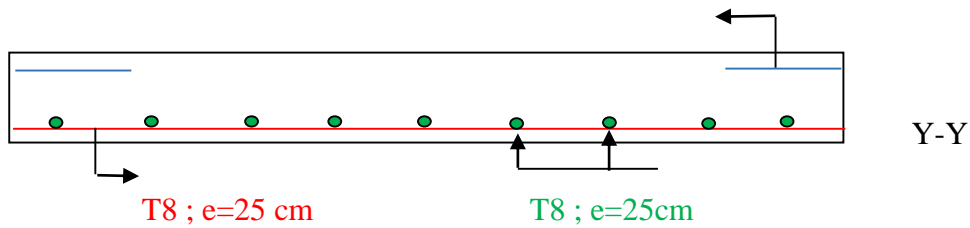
Disposition constructive des armatures de la dalle pleine.
